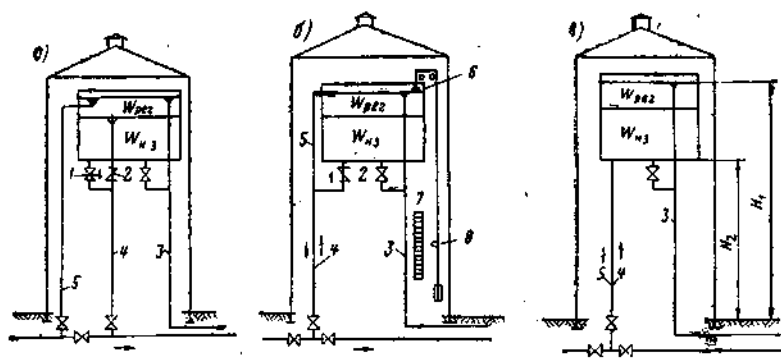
Схемы присоединения водонапорных баков к водопроводной сети
